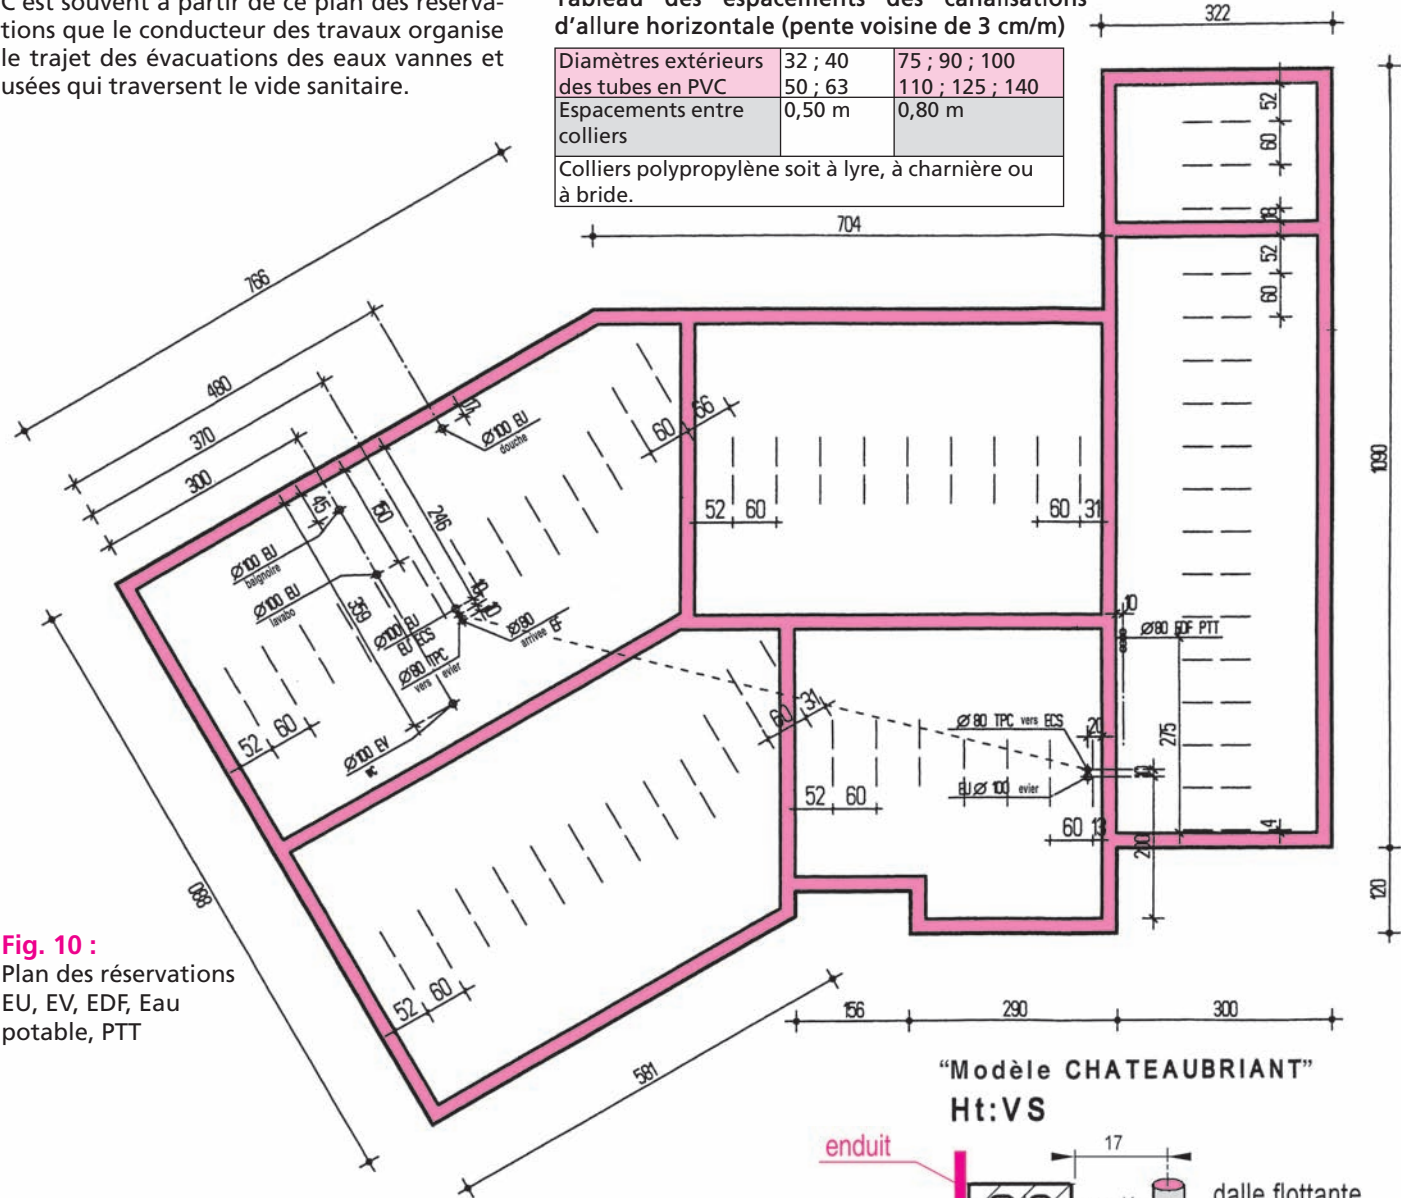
Plan des réservations EU, EV, EDF, Eau potable, PTT
